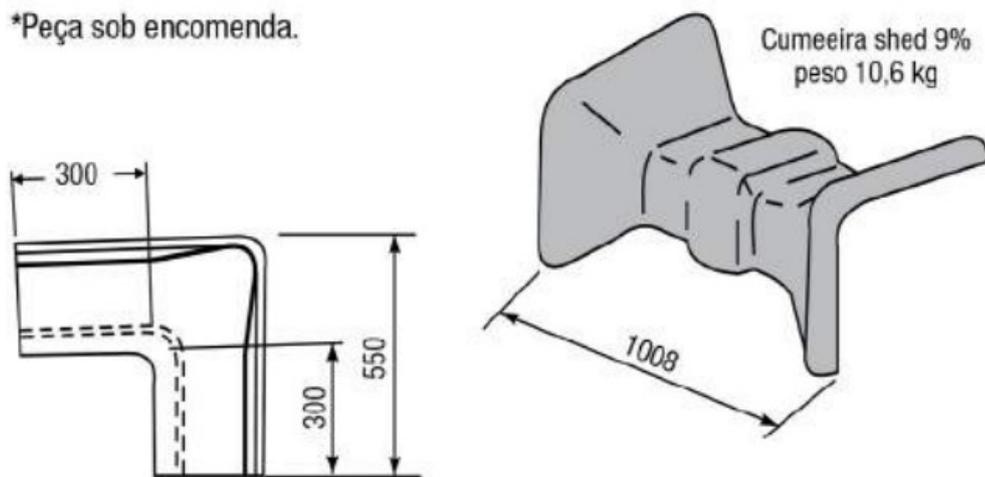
Perfil e Perspectiva da telha calhetão conforme fabricante
